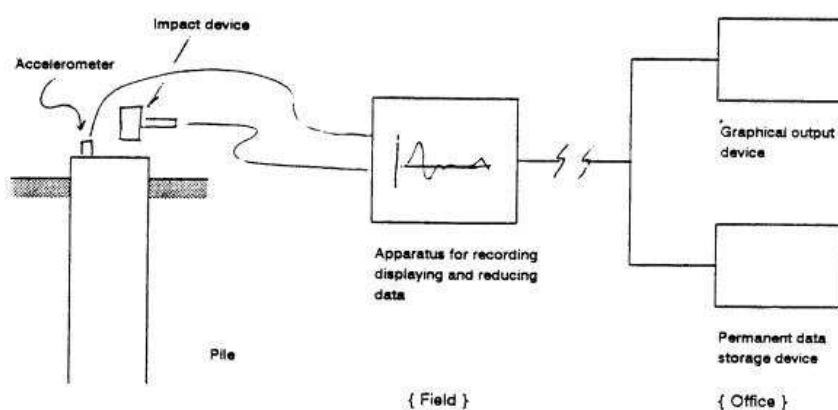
Schema dello svolgimento della prova PIT
